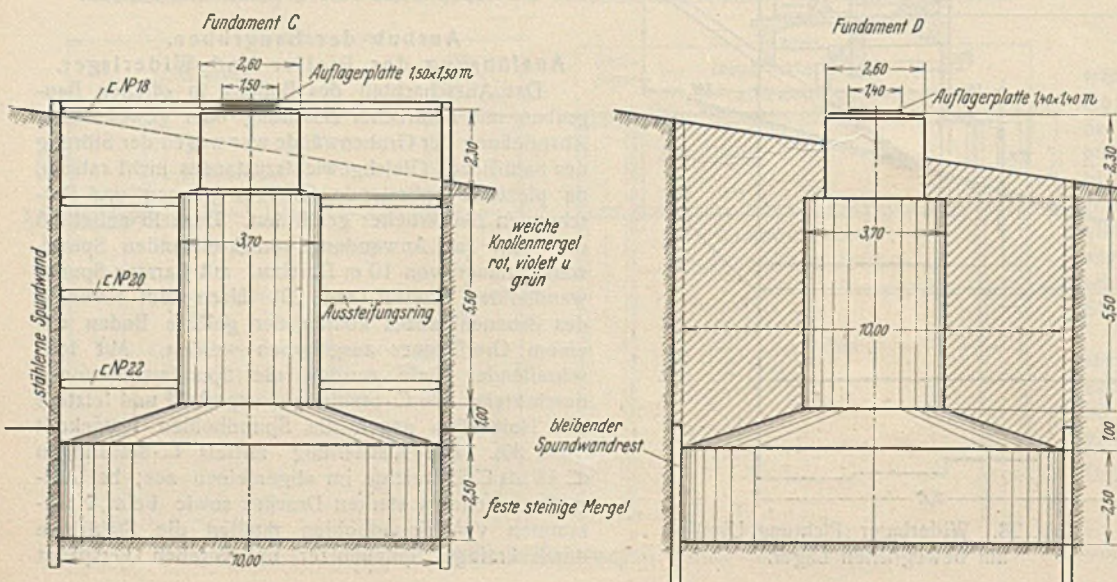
Pfeilergründung vor und nach der Verfüllung.
